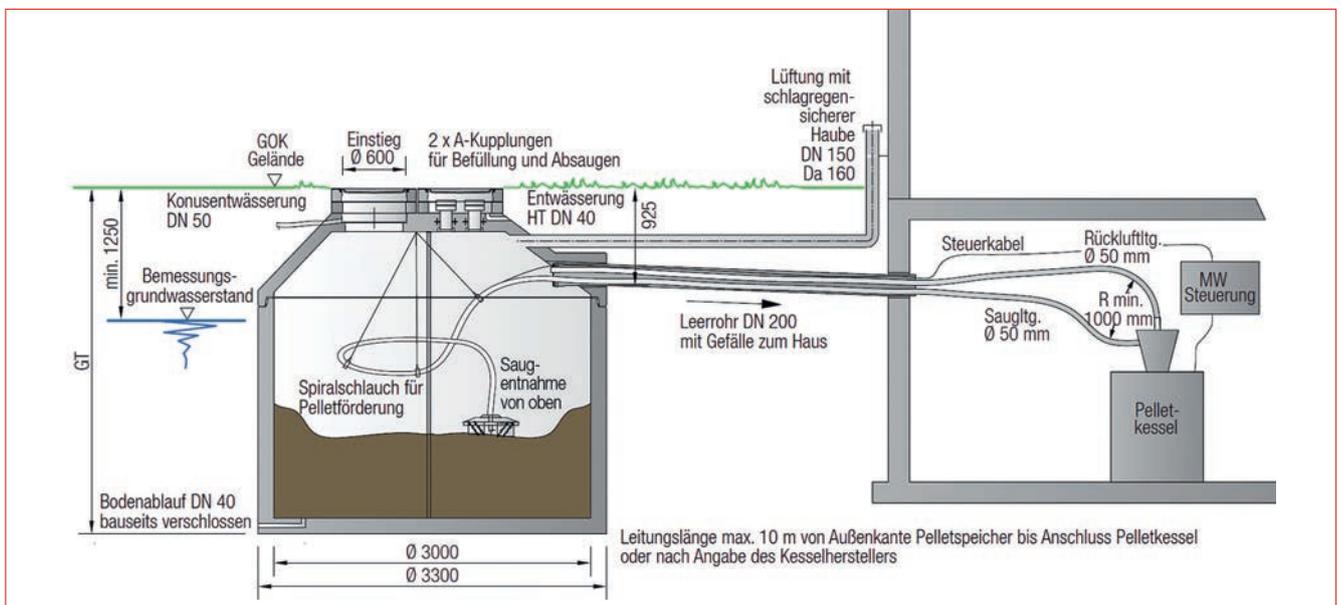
Erdlager aus Beton mit Saugentnahme von oben
